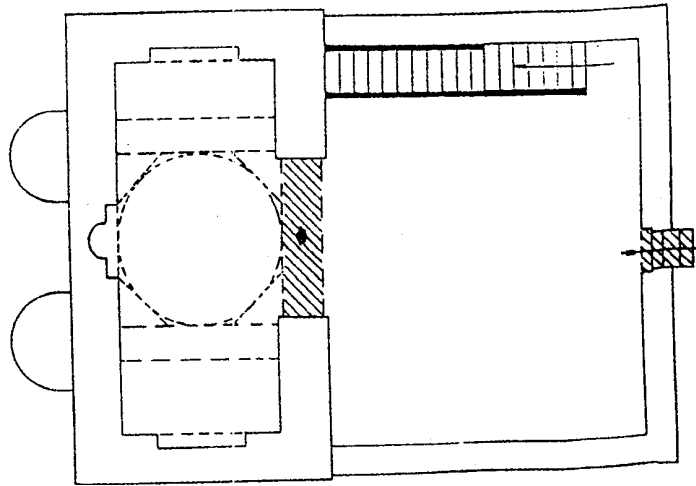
مسقط أفقى لمسجد حاجي
